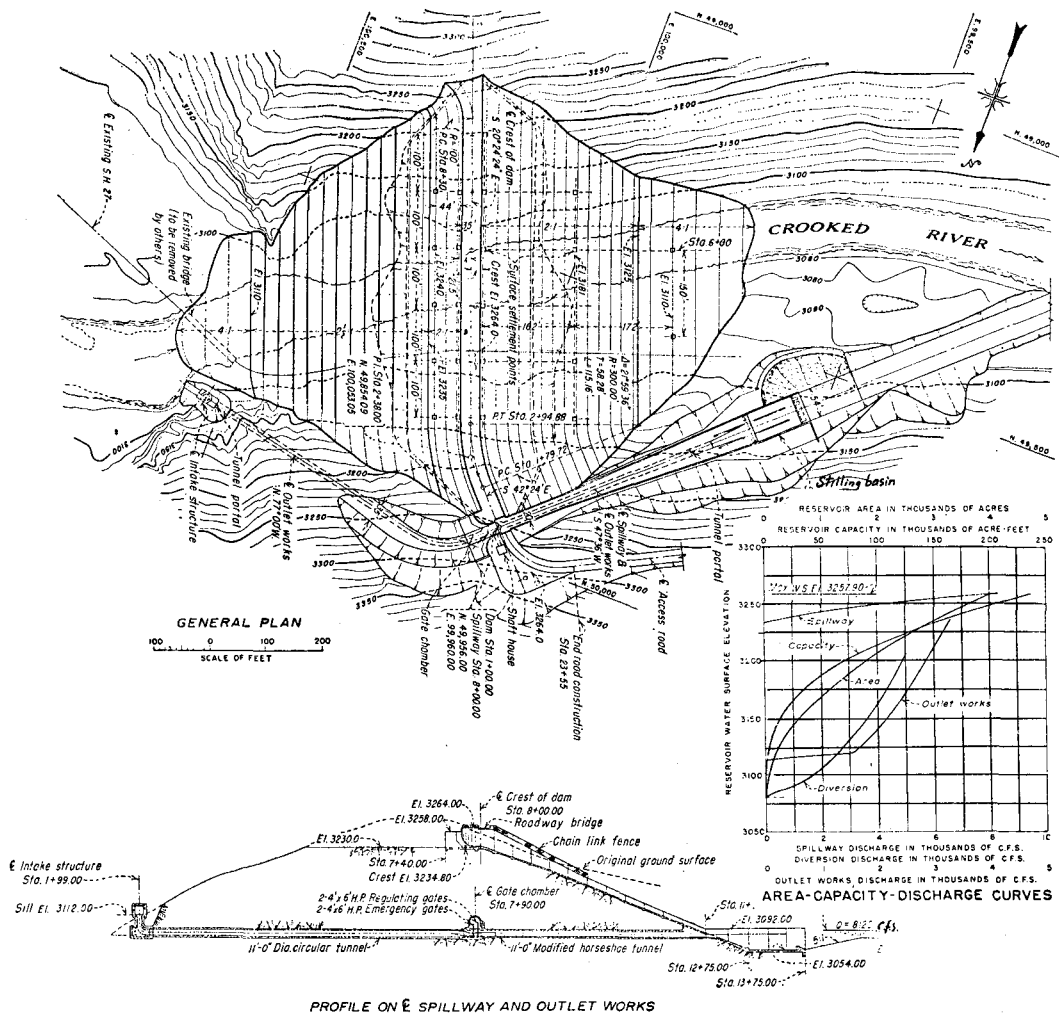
Prineville ダム (米園開拓局 U.S.B.R.) の outlet works¹³⁾
